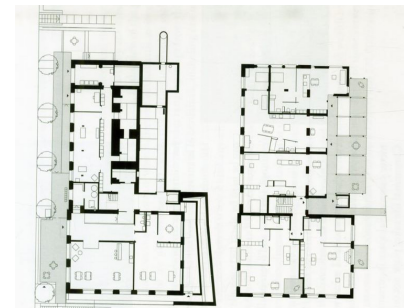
Planta baja y planta primera de Solinsieme, 2002.
